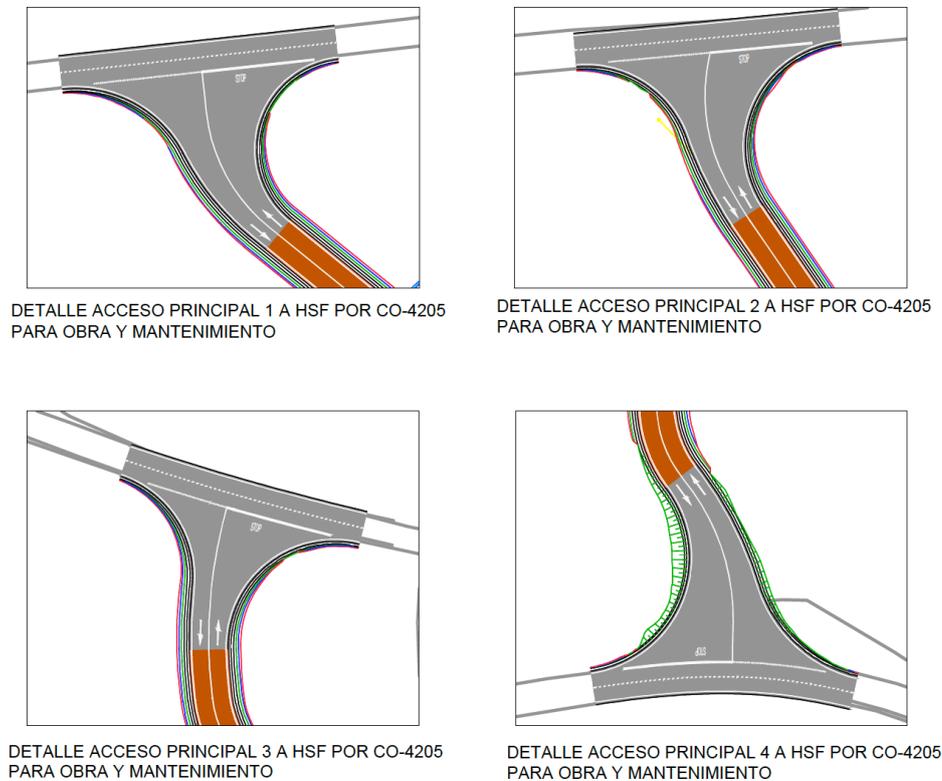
Accesos a la Planta Solar Fotovoltaica (Detalle).
